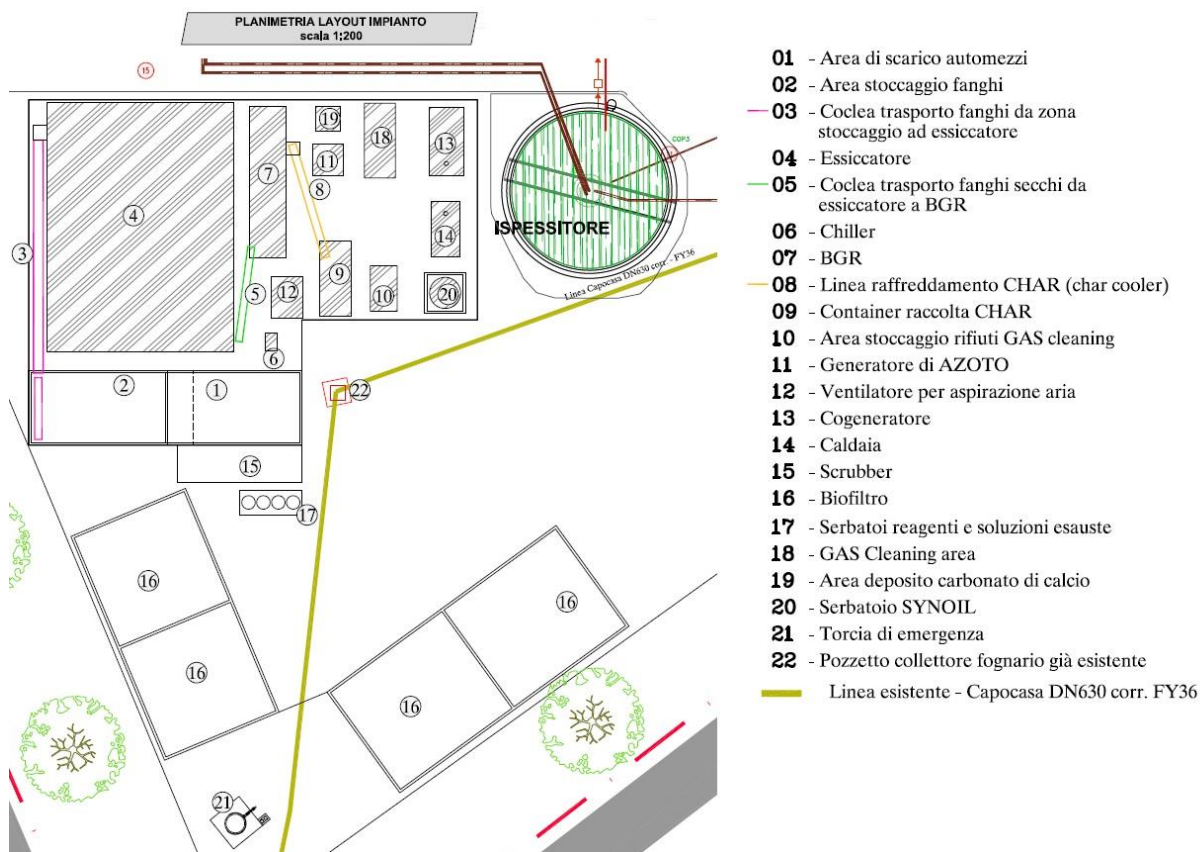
Layout della nuova sezione fanghi presso l'impianto di depurazione Basso Tenna CIIP spa
